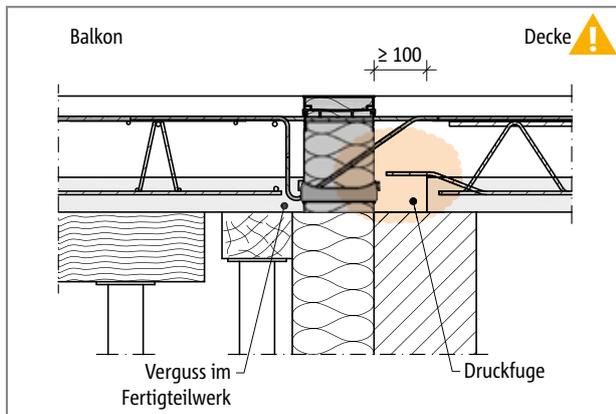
Schöck Isokorb® Typ KXT: Direkte Lagerung, Einbau in Verbindung mit Elementplatten (hier: $h \leq 200$ mm), Druckfuge deckenseitig
